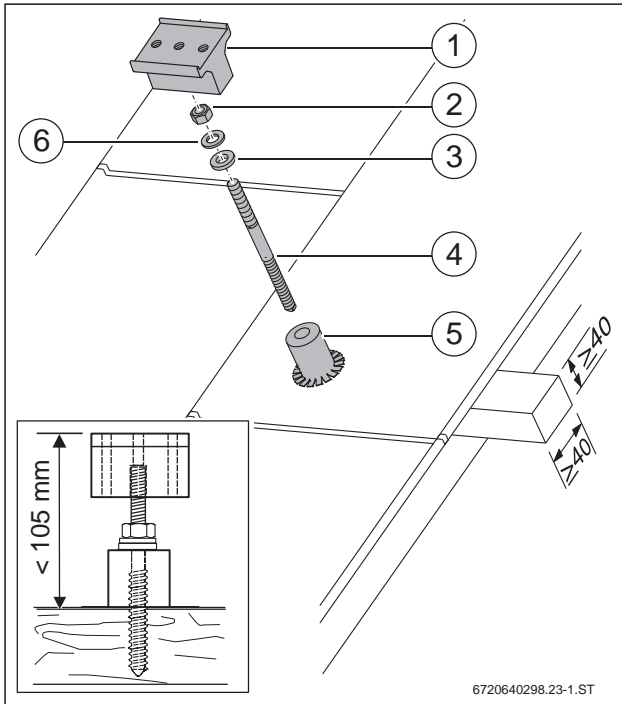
Beispiel für die Befestigung der Profilschienen bei der Aufdachmontage von SKS5.0 auf einer Wellplatten-Eindeckung (Maße in mm)
